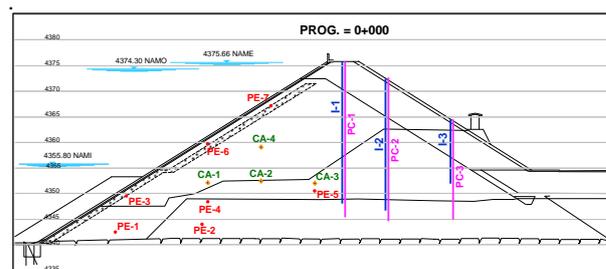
Ubicación de piezómetros, celdas de asentamiento e inclinómetros en la Sección 1-1 de la presa Pillones
